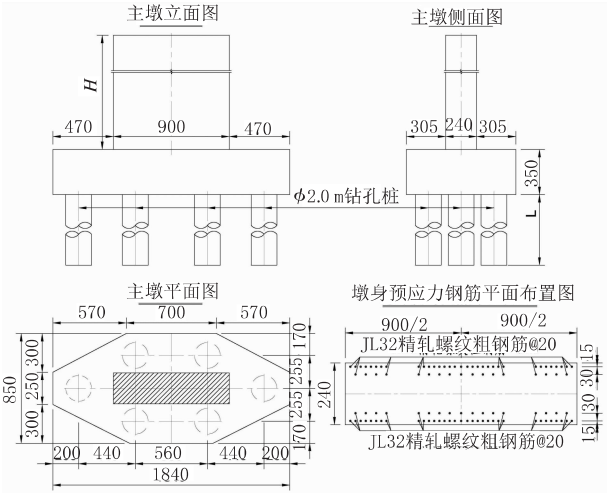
主墩结构图及墩身预应力平面布置图(单位:cm)
